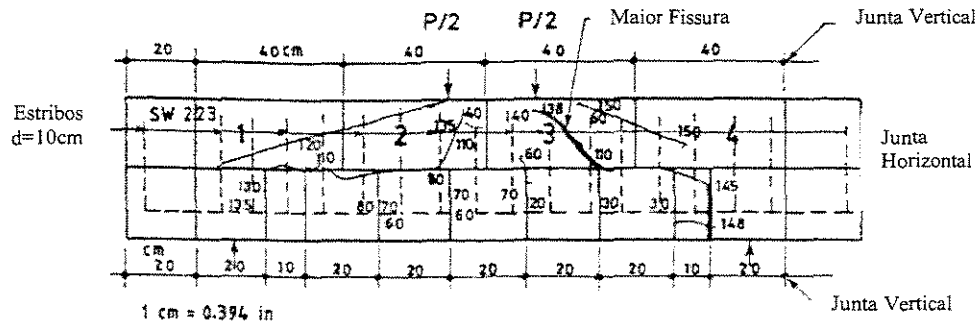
DIAGRAMA DE FISSURAÇÃO TÍPICA DE
